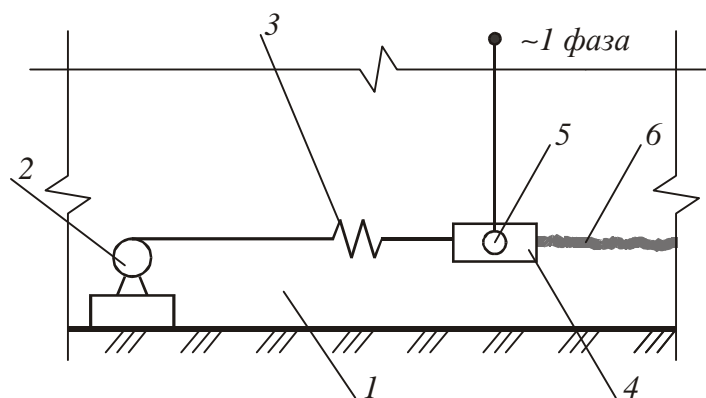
Устройство гидроизоляции в кирпичной стене электротермическим способом:
